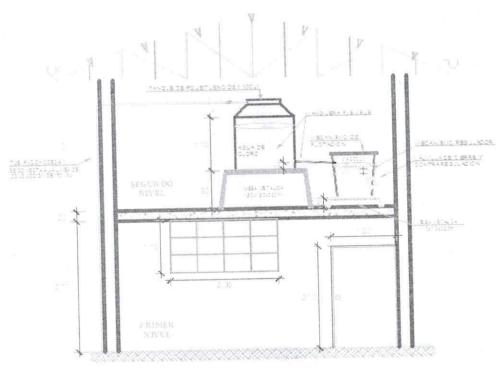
Corte Longitudinal de la Caseta de Cloración proyectada
